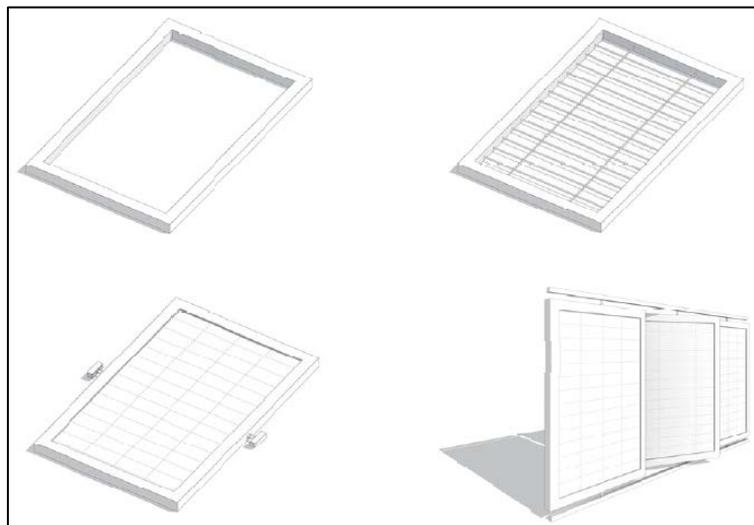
Casa Fanego, Proceso Constructivo de Paneles Móviles.
